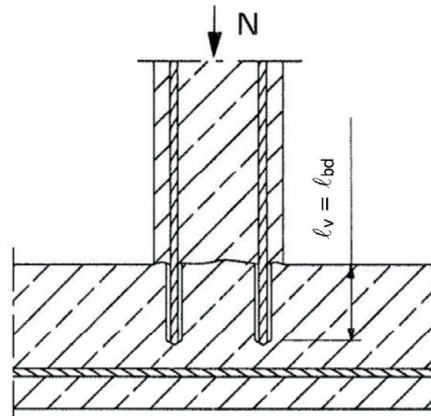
Junta superpuesta en los cimientos de un muro o columna donde las barras de refuerzo están sometidas a tensión
